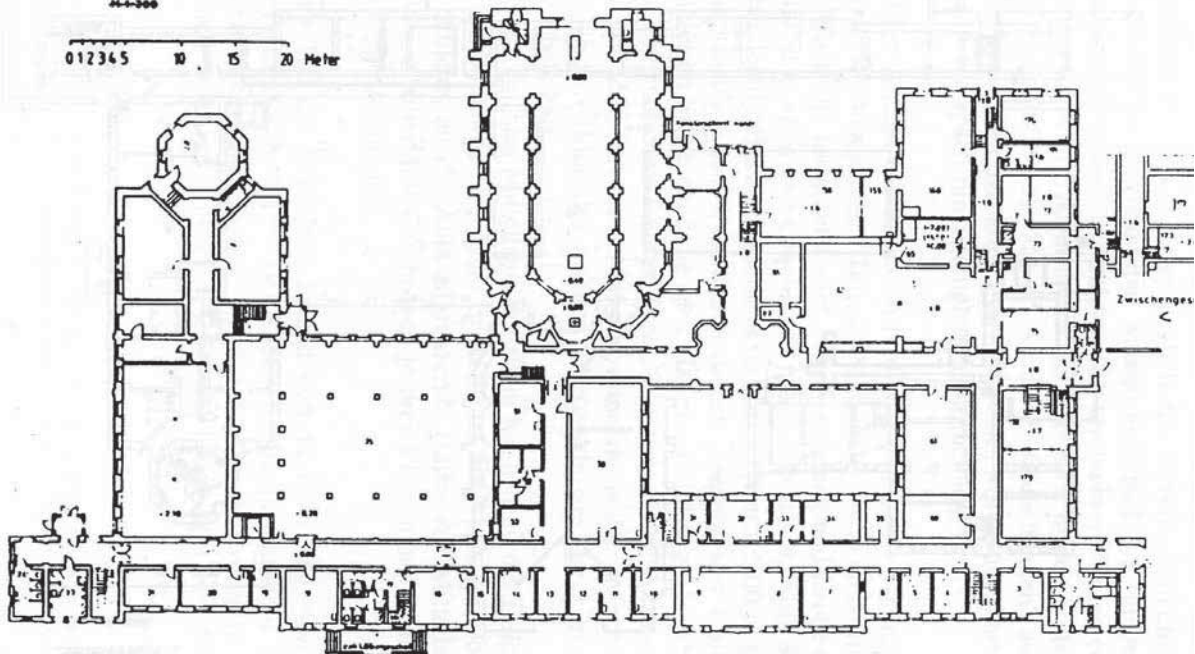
Lageplan des Missionshauses aus dem Jahr 1895-96
